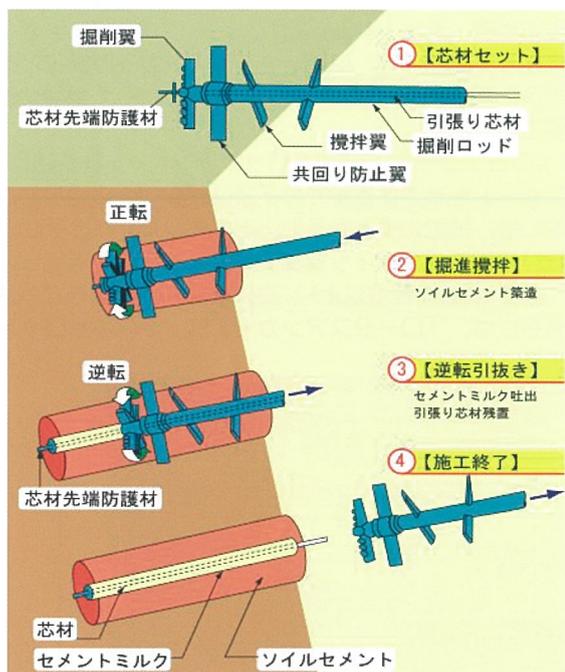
通常式ラディッシュアンカー(大径)の施工手順の概要
